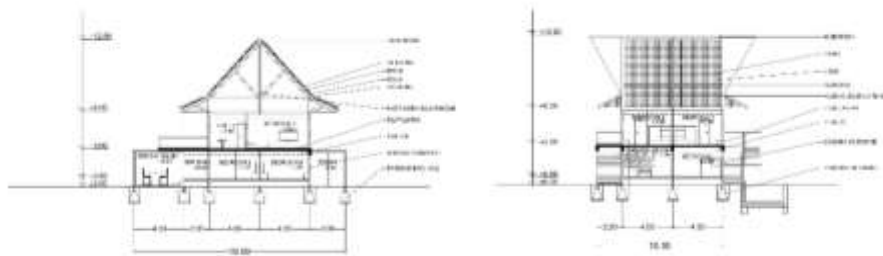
Penerapan Struktur Pada Massa Utama
